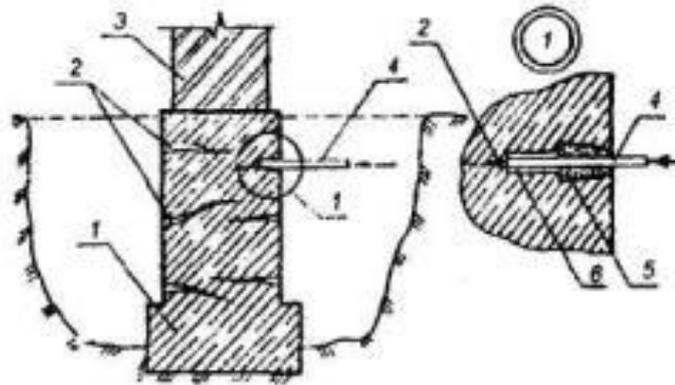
1 - существующий фундамент, имеющий вертикальные и горизонтальные трещины; 2 - трещины; 3 - кирпичная стена; 4 - иньектор для нагнетания компаунда из синтетических смол под давлением 0,6-1,2 МПа; 5 - борозда шириной 35-40 мм, выполненная дисковой пилой или отбойным молотком; 6 - отверстие, пробуренное перфоратором на глубину 100-150 мм.
